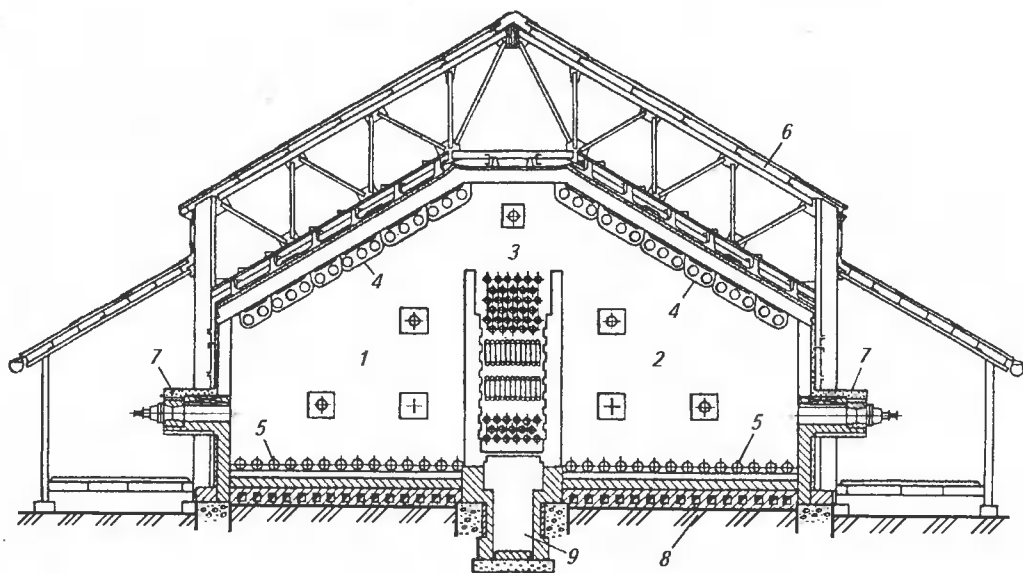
Схема типовой двухкамерной трубчатой печи шатрового типа с наклонными сводами (поперечный разрез):
